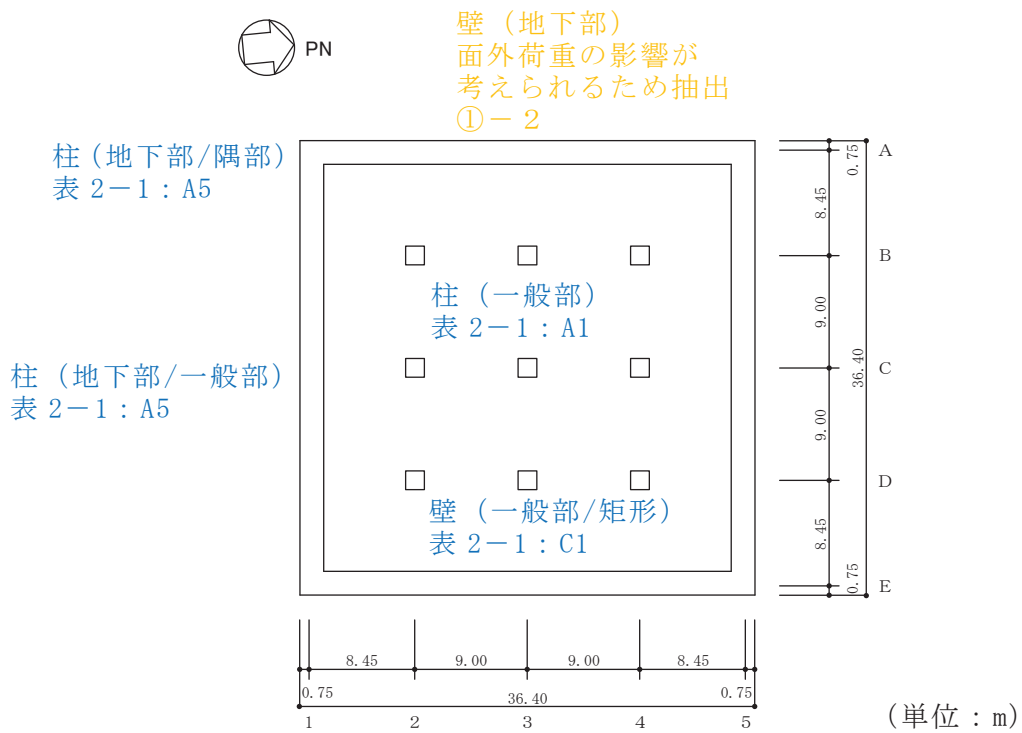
(2) 緊急時対策建屋の概略平面図 (0. P. 57. 3m)
